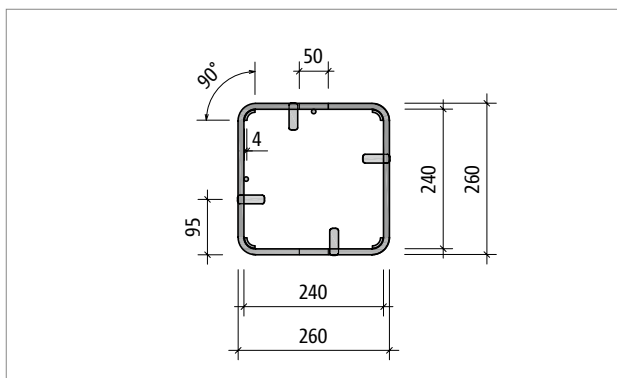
Schöck Sconnex® Typ P-B300: Part T; geschweisste Bügel und Biegeformsegmente aus Edelstahl
